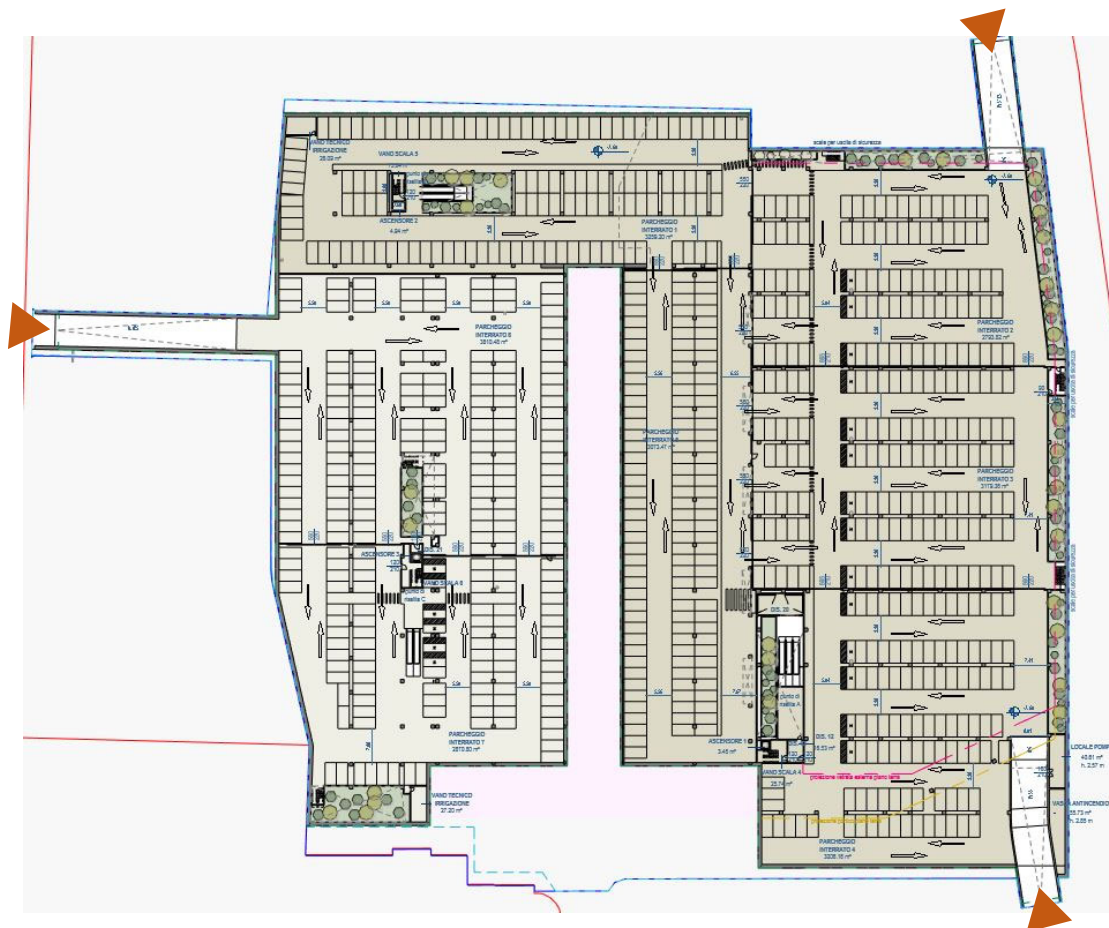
Planimetria del Lotto 1 con accessi carrabili
